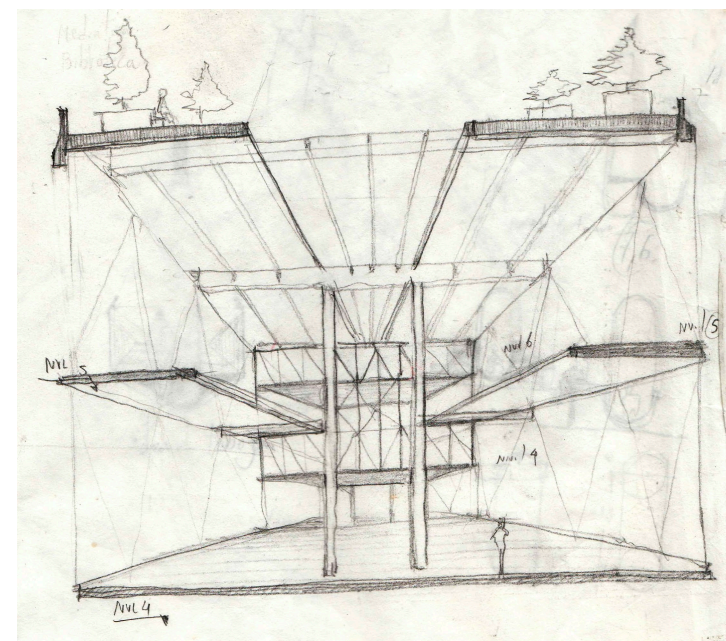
Croquis sección interior, propuesta espacial de galerías conectadas por un vacío continuo
